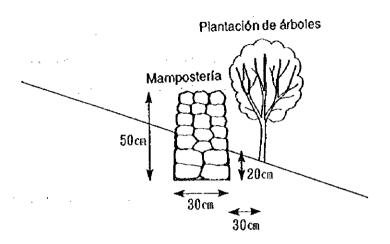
Esquema de una Obra Típica de Mampostería y Plantación de Arboles
